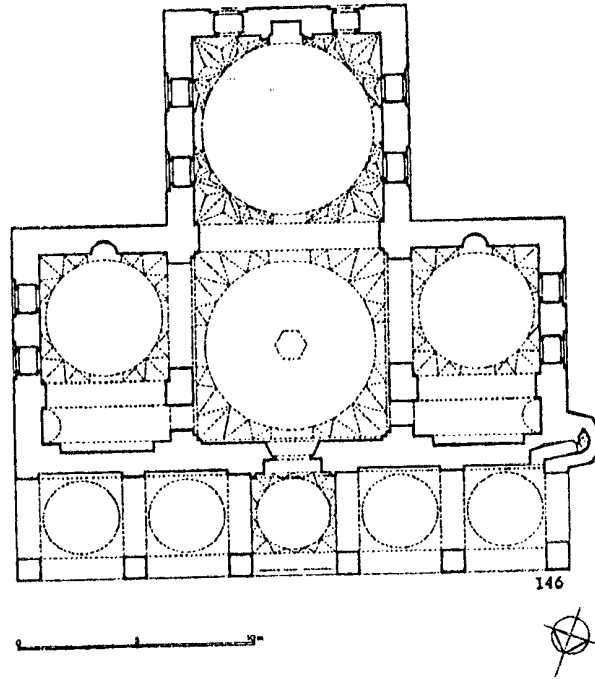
مسقط أفقي لجامع مراد باشا في استانبول (عن : Kuran)
